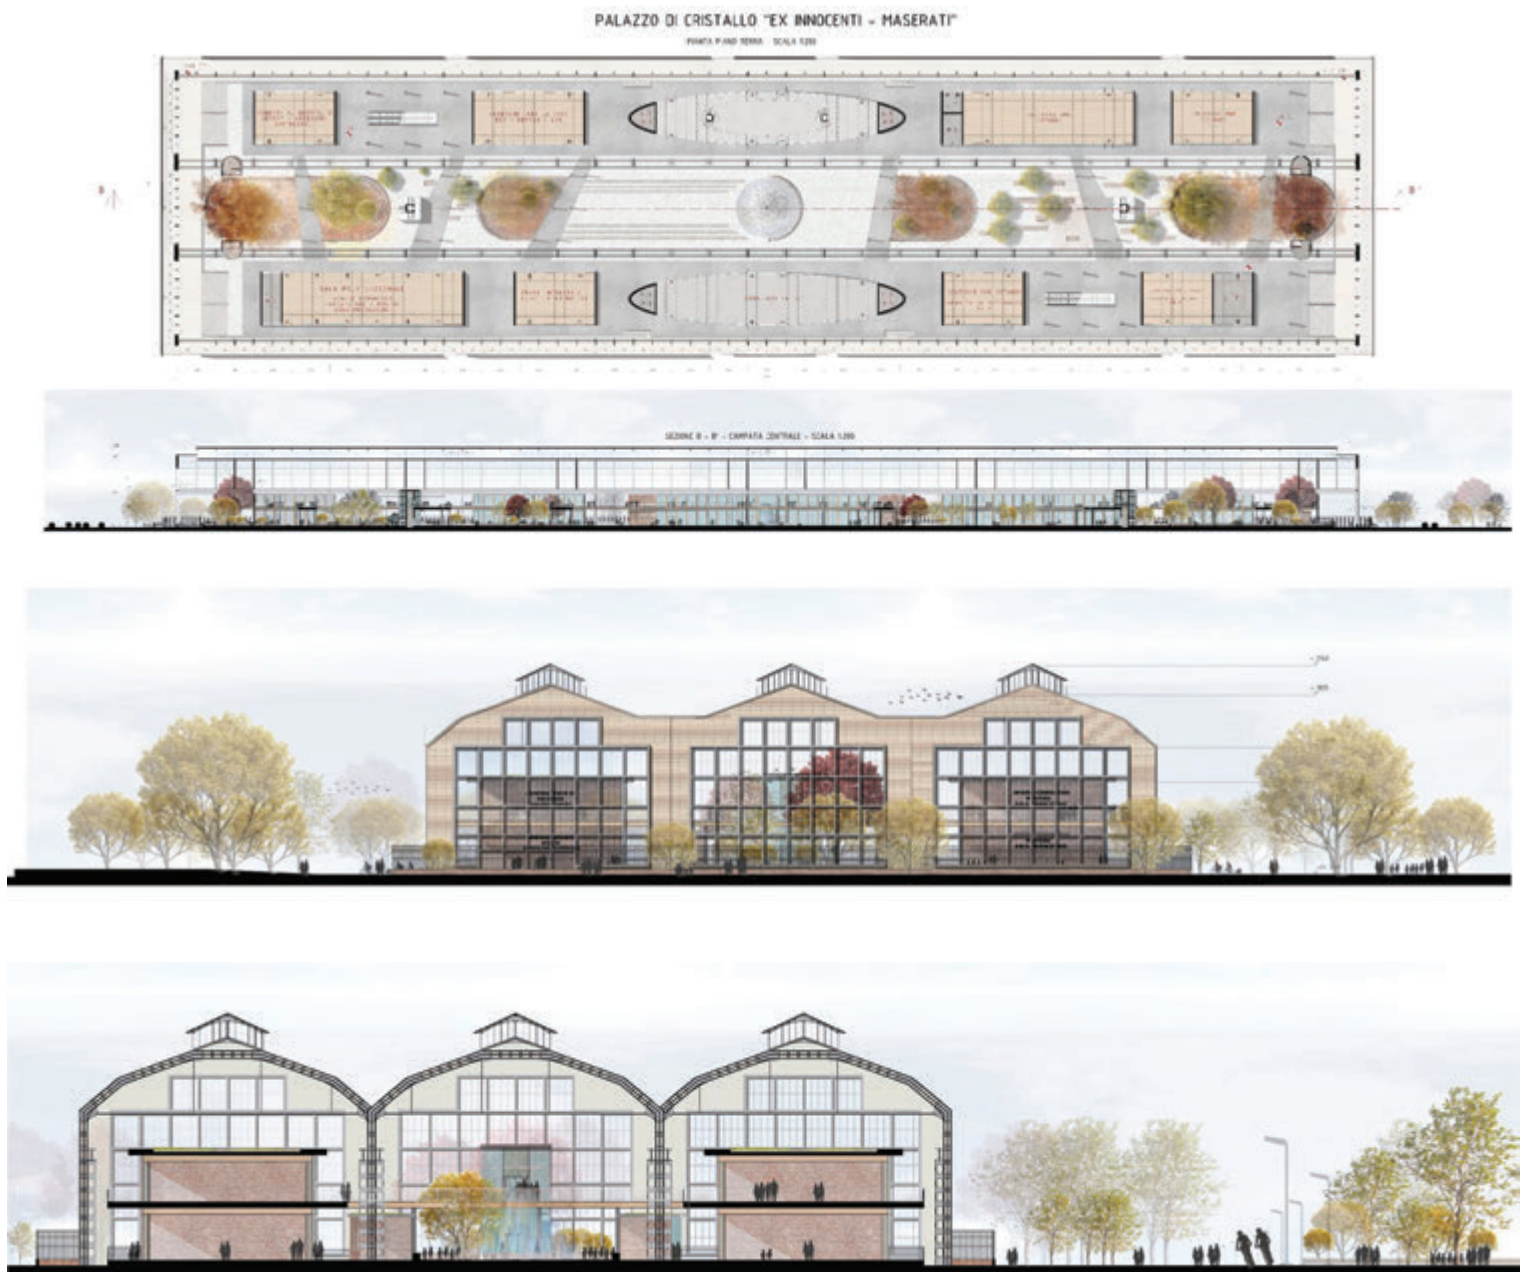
| PROGETTO: PIANTA PIANO TERRA, SEZIONE LONGITUDINALE della CAMPATA CENTRALE, PROSPETTO SUD - valorizzazione del mantenimento della facciata con caratteri morfologici, architettonici e tipologici appartenenti all'architettura industriale italiano del XX secolo, SEZIONE CENTRALE con la rappresentazione di una fontana d'acqua e dell'albero, quali elementi naturali che simboleggiano la rinascita del "Palazzo di Cristallo" ex Innocenti Maserati
